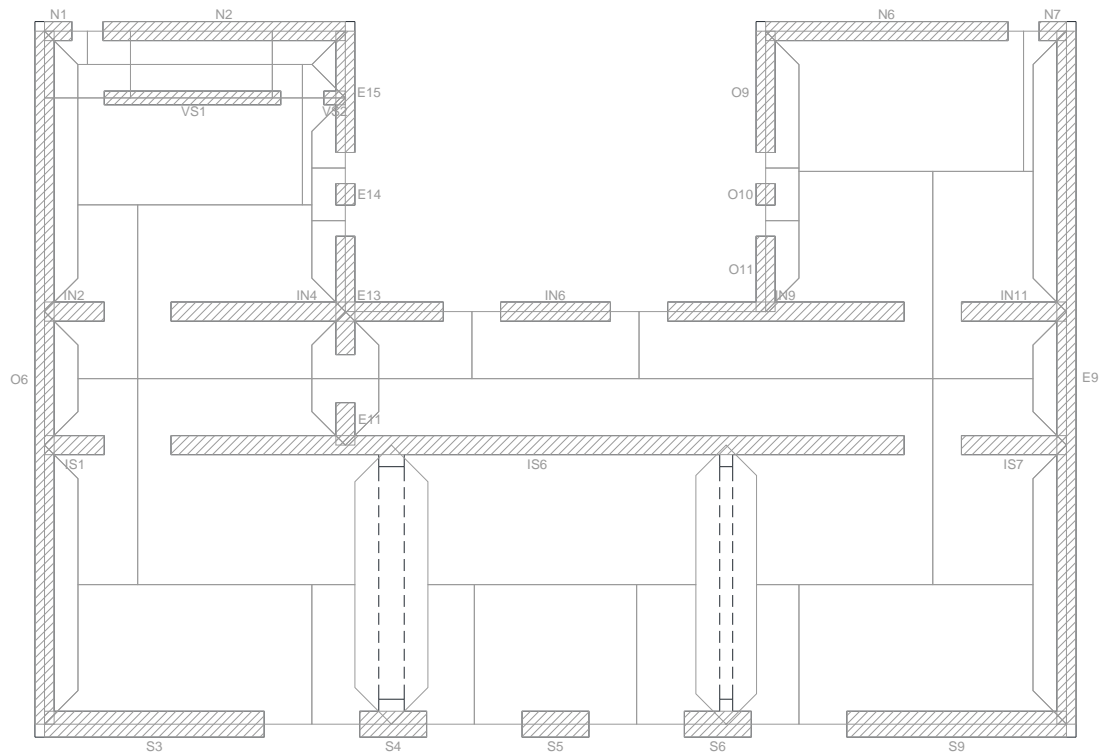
Schema degli elementi resistenti con l'indicazione delle aree gravanti sulle murature (piano seminterrato)
